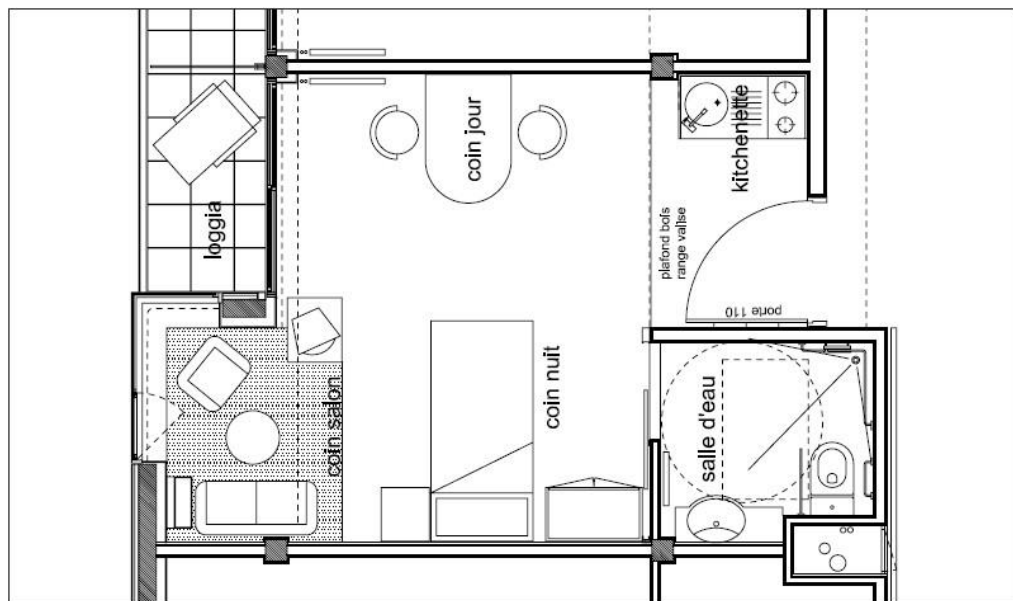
L'espace privatif de 25 m² est aménagé tel un petit studio, avec une kitchenette, un coin salon, un balcon et bénéficie d'une façade largement vitrée (Source Cahier de l'AUE 2014).
